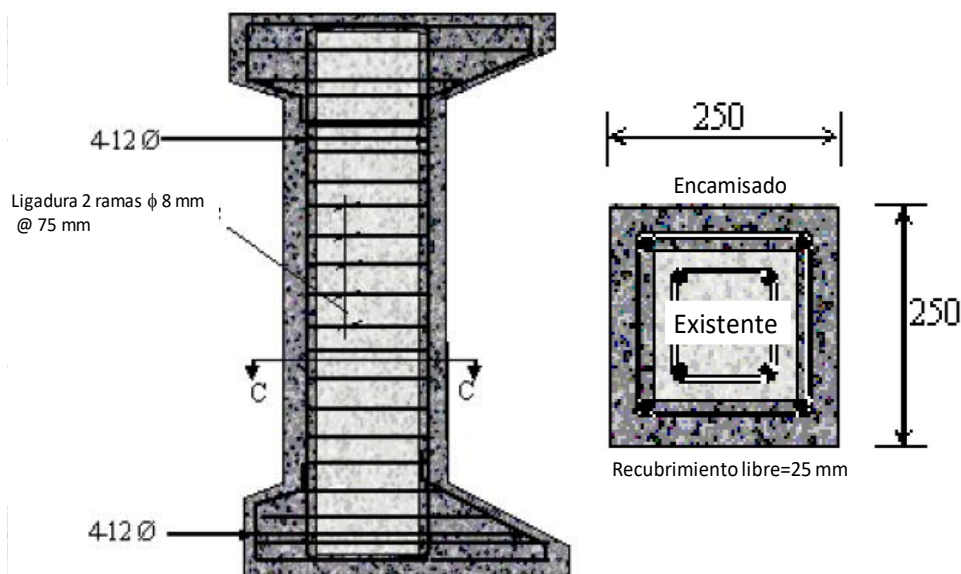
Detalles del armado y sección transversal de la columna recrecida (KALIYAPERUMAL *et al*, 2009 Modificado).
